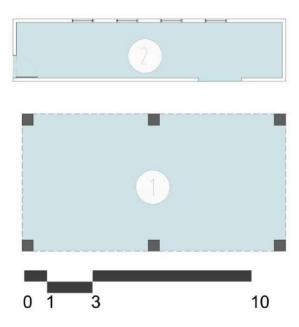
Planta 1 Bloque 61. Fuente: Equipo de diagnóstico.
